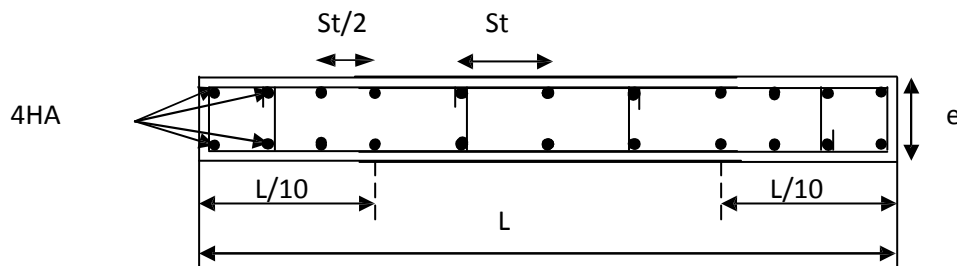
Schéma d'une coupe horizontale d'un voile
